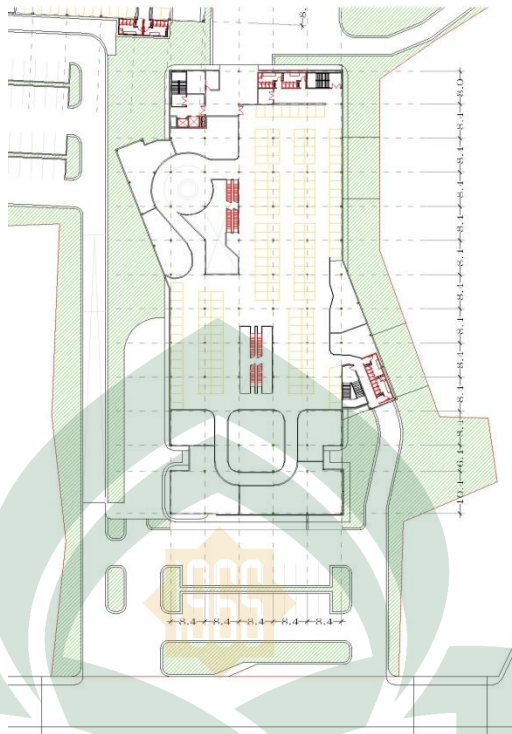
Denah lantai 1 area pedagang harian zona semi basah
